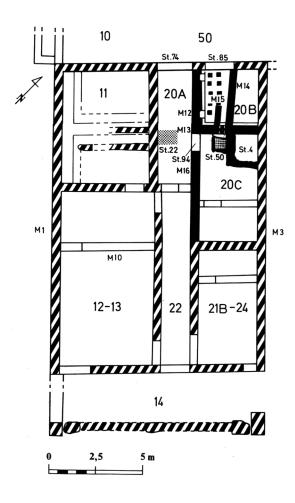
Plan schématique de l'état 4B. En hachuré, structures réutilisées; en foncé, nouvelles structures. Echelle 1:200.
